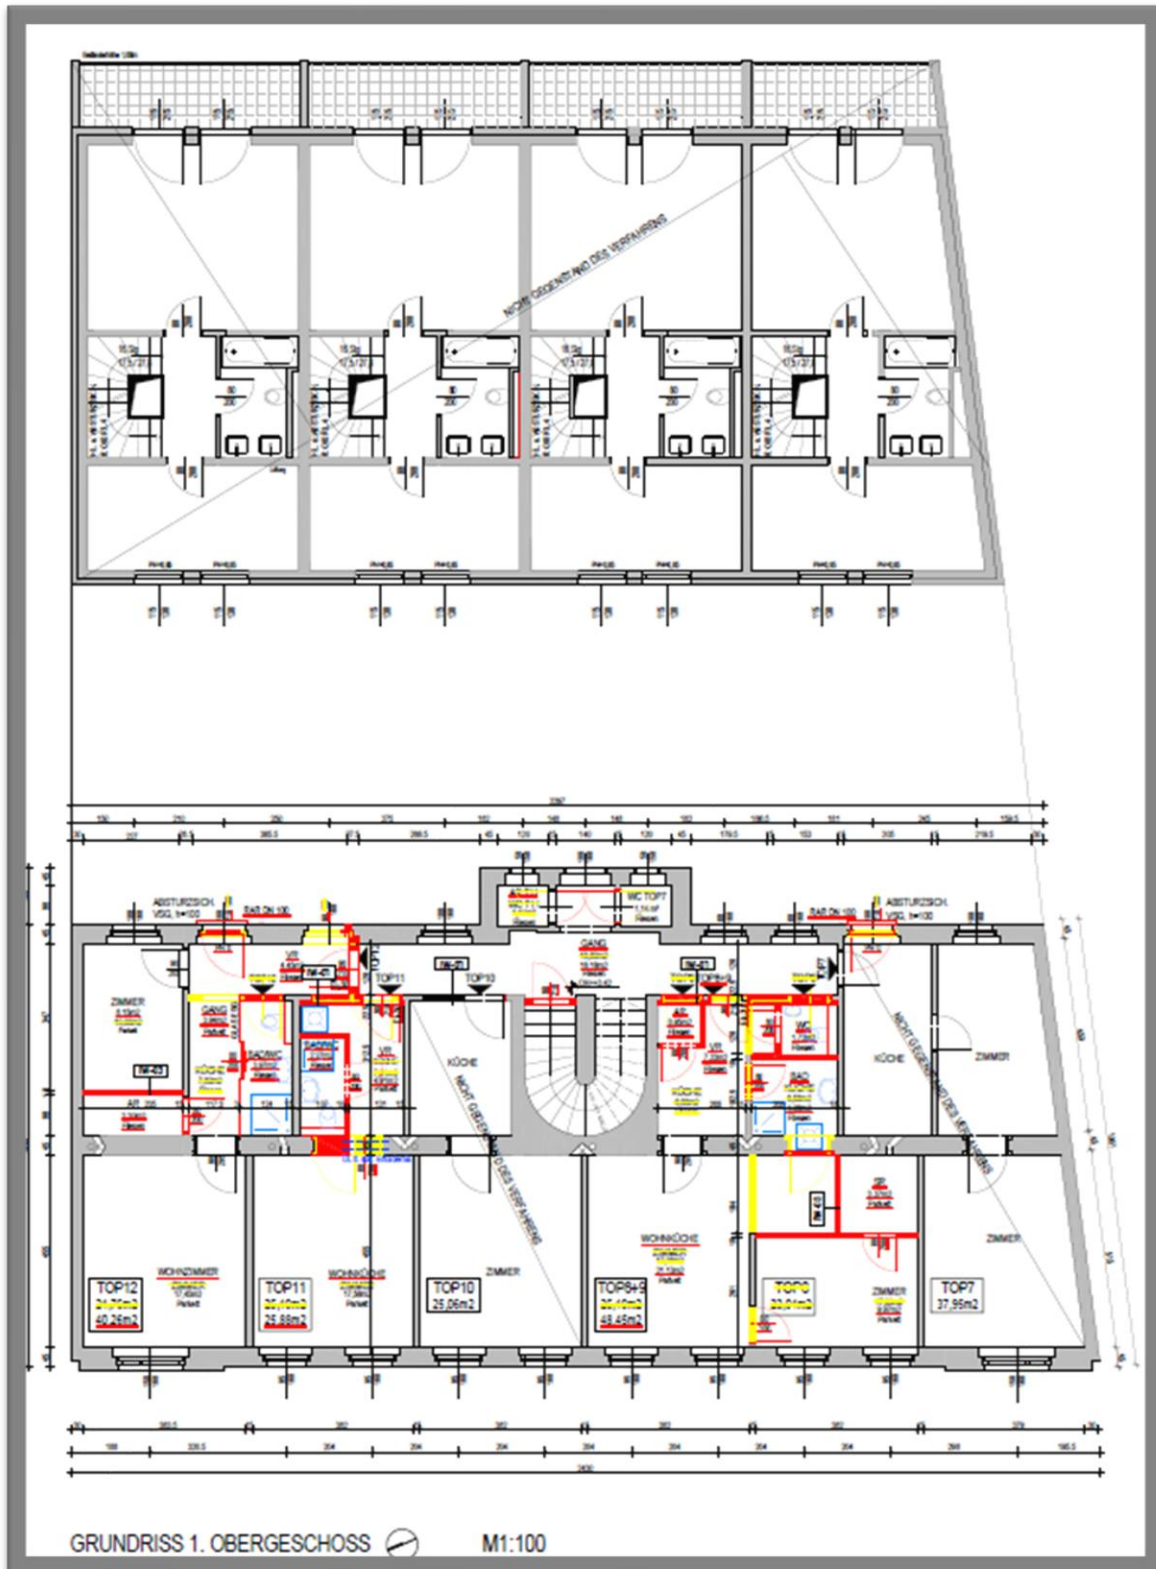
Grundriss 1. Obergeschoss
